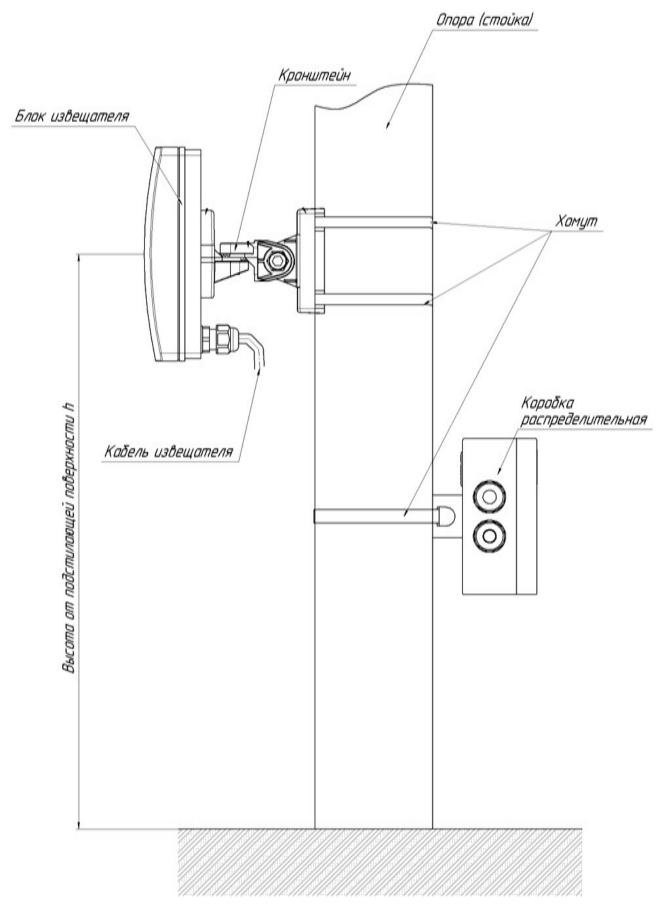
Установка блока извещателя и КР на опоре (высота установки h=0.8...0.9 м)
